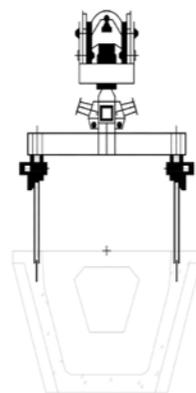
Traslado de viga por carros de avance (straddle carriers)
